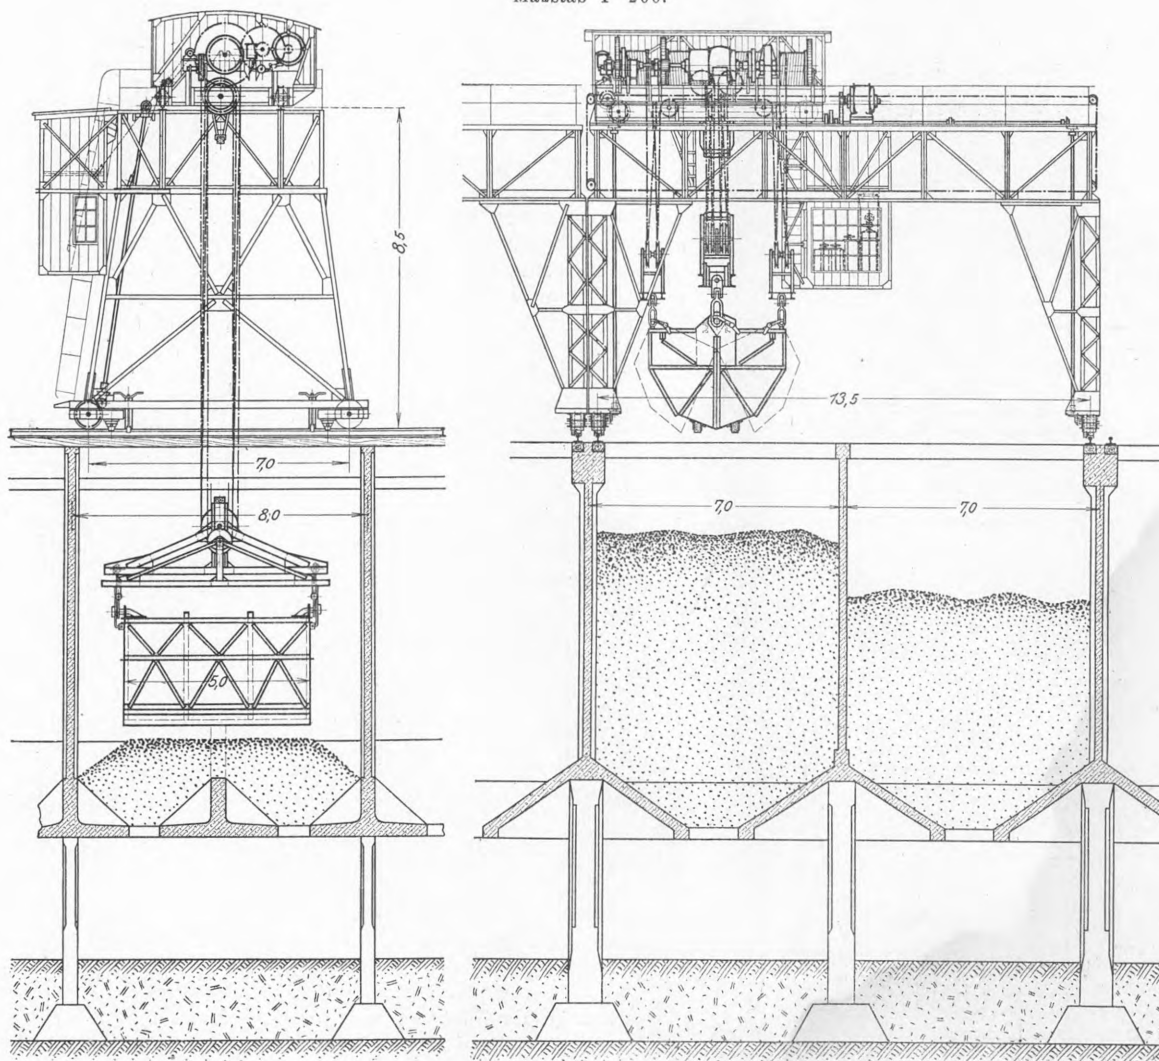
und 4. Bockkrane mit Klappkübel auf dem Betongerüst.
